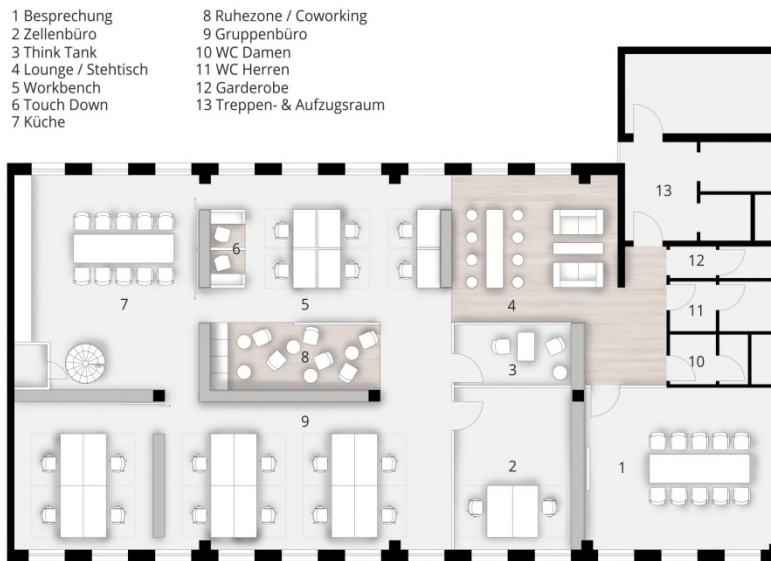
Canzler Grundriss: Beispielgrundriss für ein Multi-Space-Office auf kleinstem Raum. Zentral angeordnet befinden sich Lounge-, Ruhe- und Coworking-Zonen sowie ein Think Tank; Desk-Sharing-Arbeitsplätze, Gruppen-, Zellenbüros und Besprechungsräume gruppieren sich außen herum.
